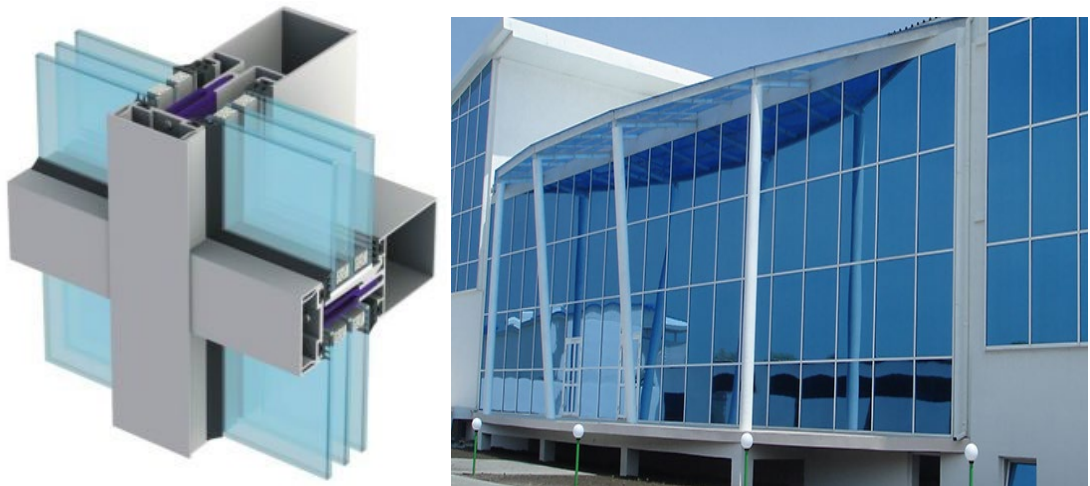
Фасади будинків з вентильованою обробкою
